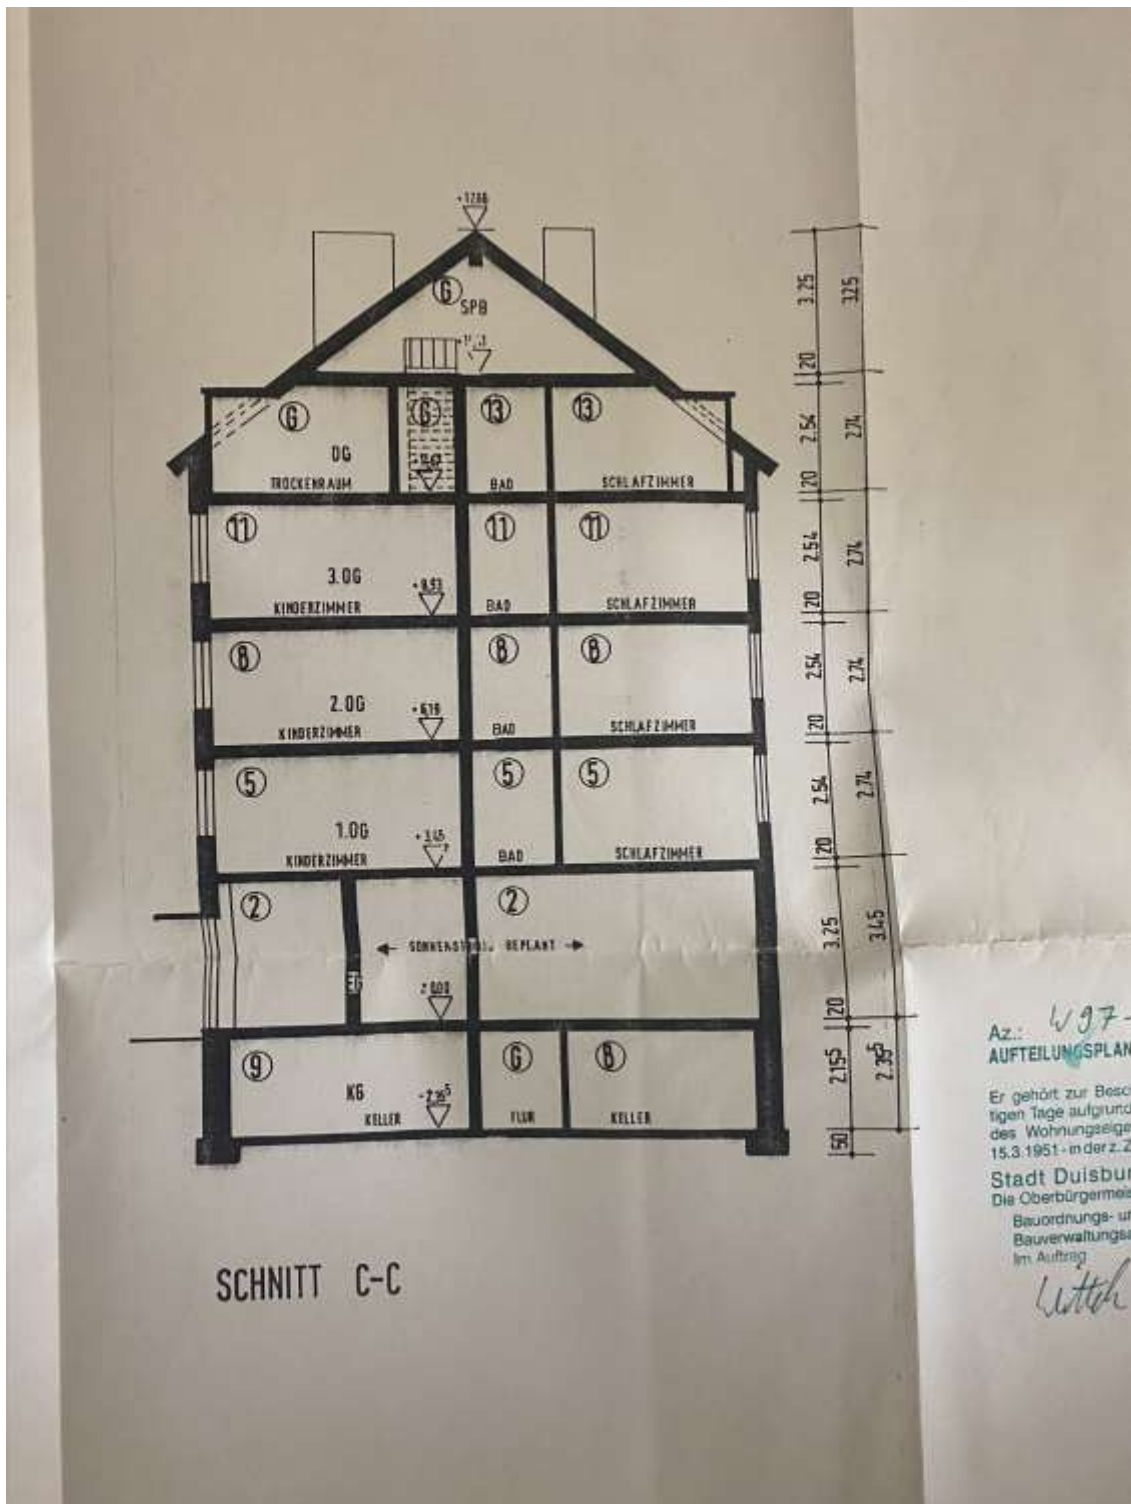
Schnitt / Quelle: Aufteilungsplan Grundakte
